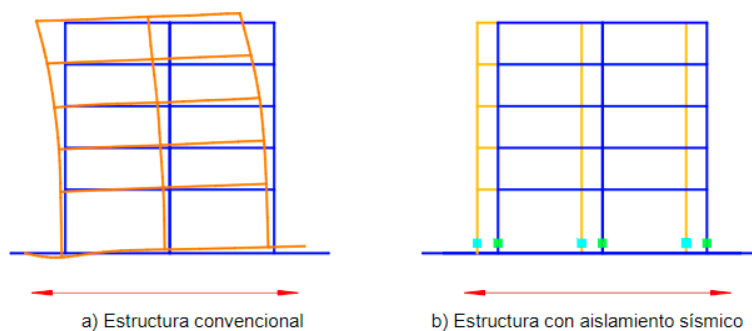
Comparación de la respuesta entre estructuras convencionales y con aislamiento sísmico
